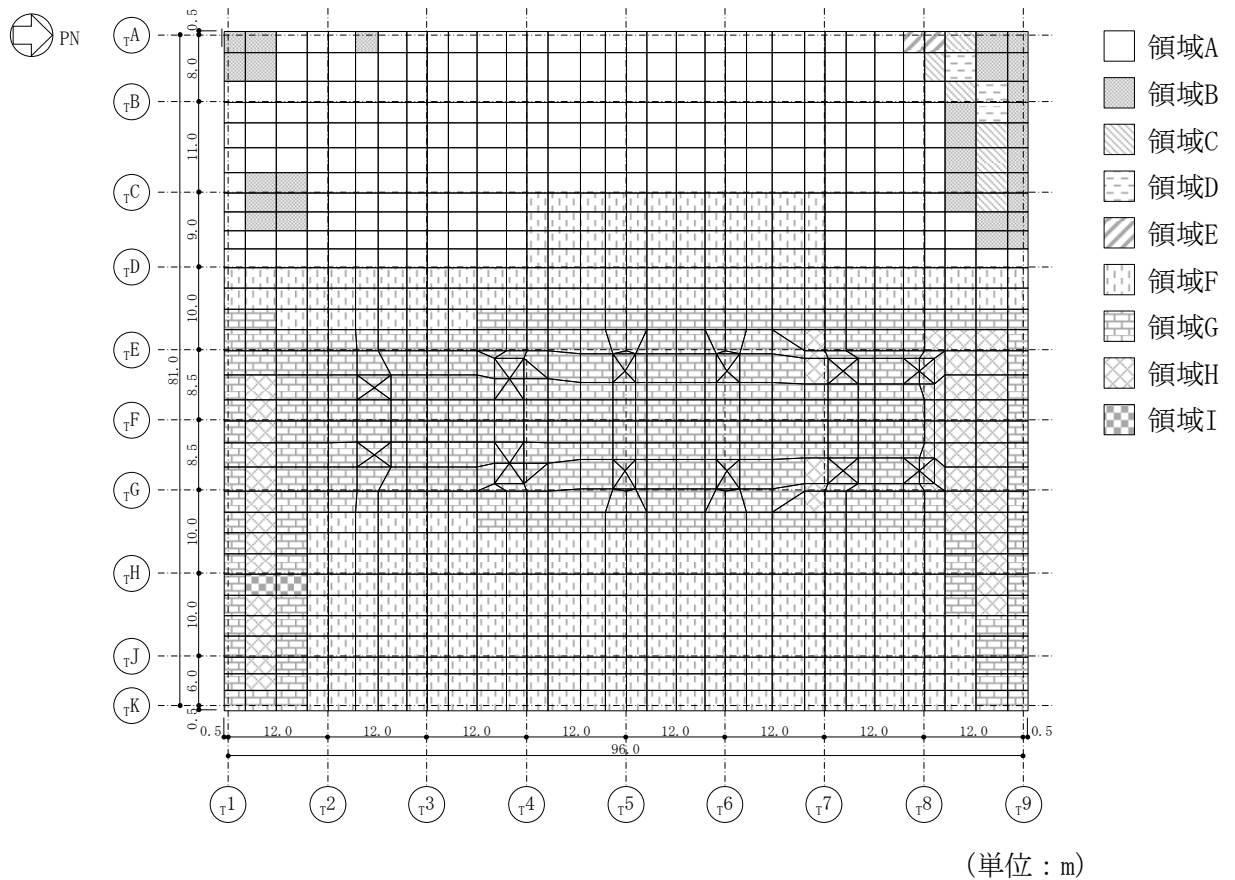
基礎スラブの配筋領域図 (NS 方向, 上ば筋)
